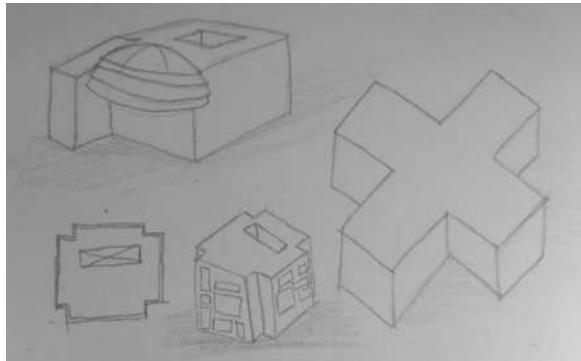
Primer boceto fachada. Al ser un proyecto con construcción pre-existente se pensó en trabajar la parte exterior en cuanto a la fachada, y re-acomodar la planta arquitectónica sin extender tanto el área de construcción.
